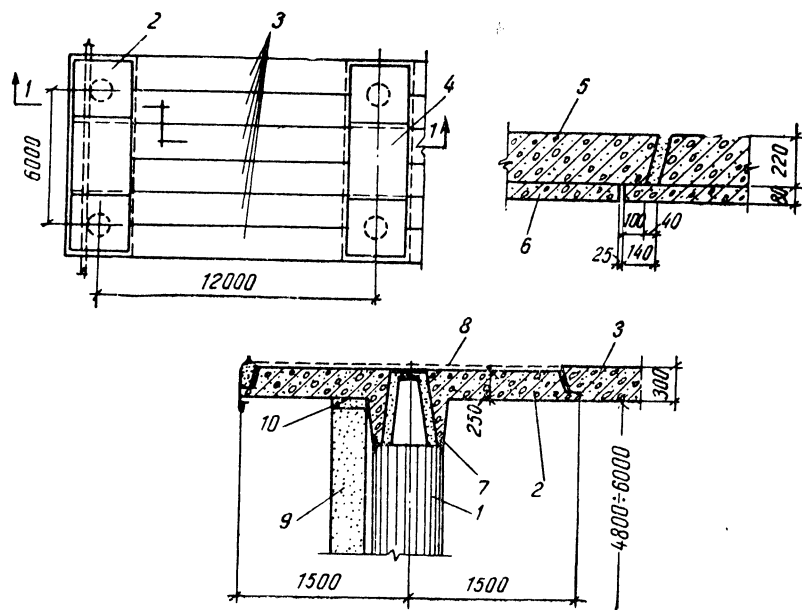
Комплексное покрытие из плоских керамзитобетонных плит:
